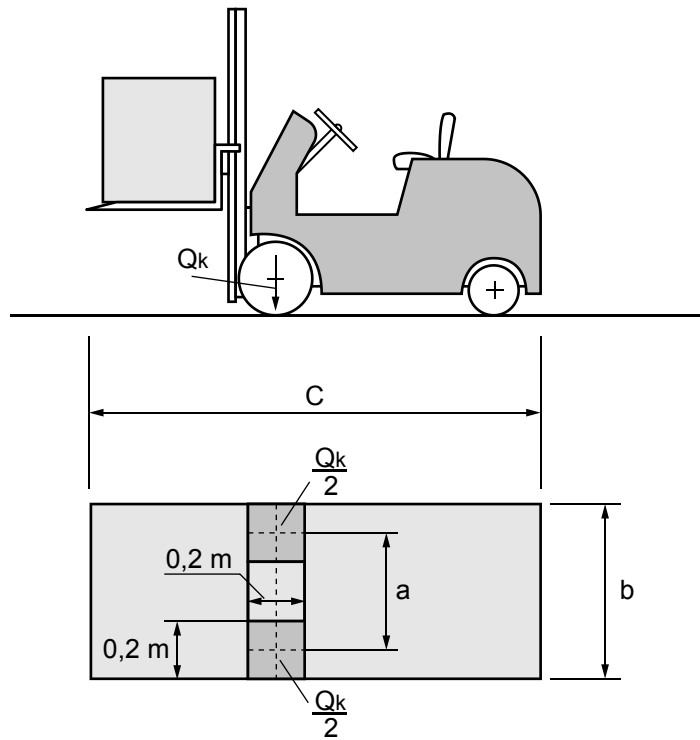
Dimensões de empilhadeiras ou minicarregadeiras
